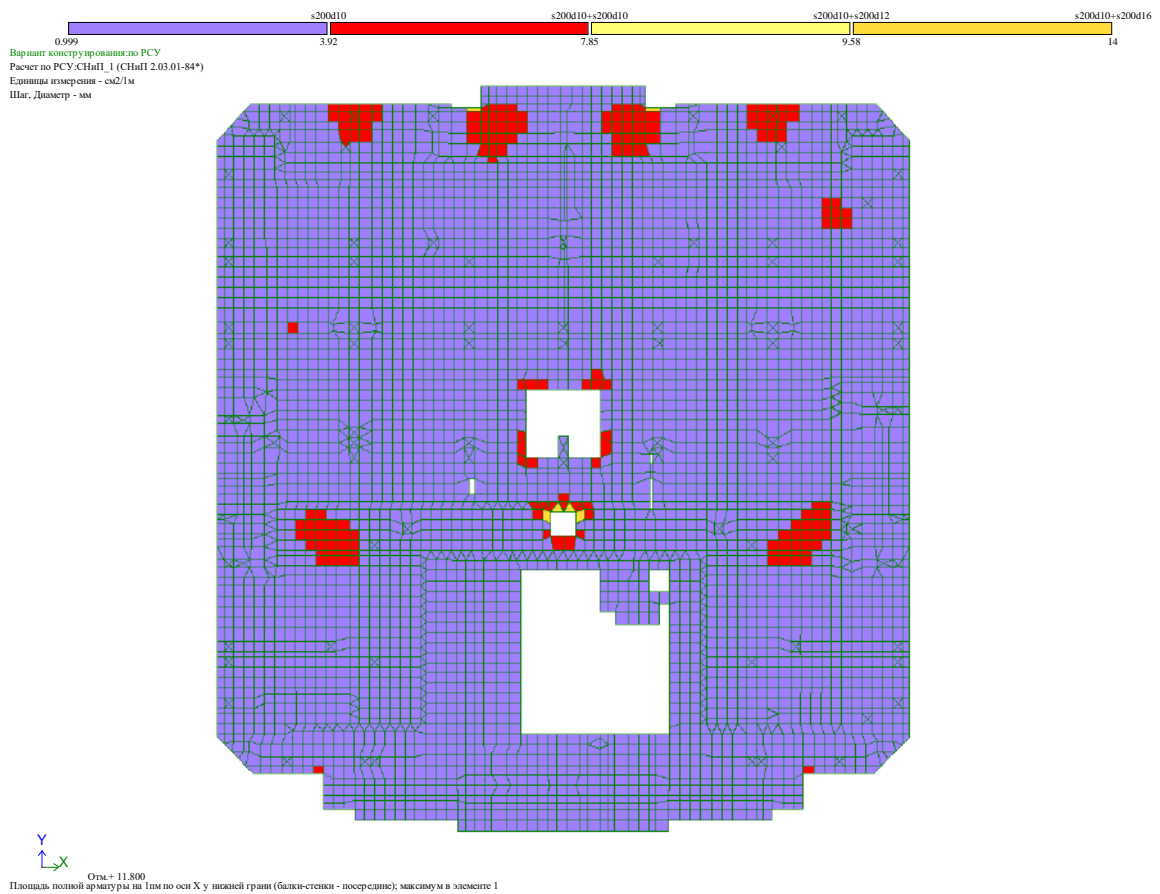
Мозаика армирования нижней арматуры вдоль б.о.
